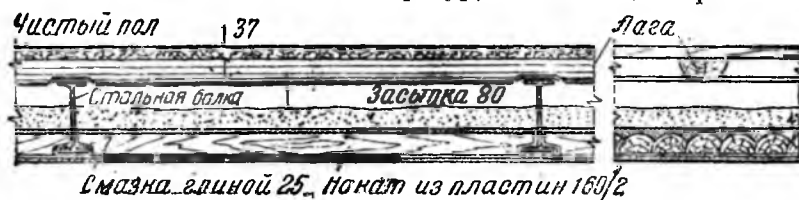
Перекрытие по стальным балкам с деревянным накатом
